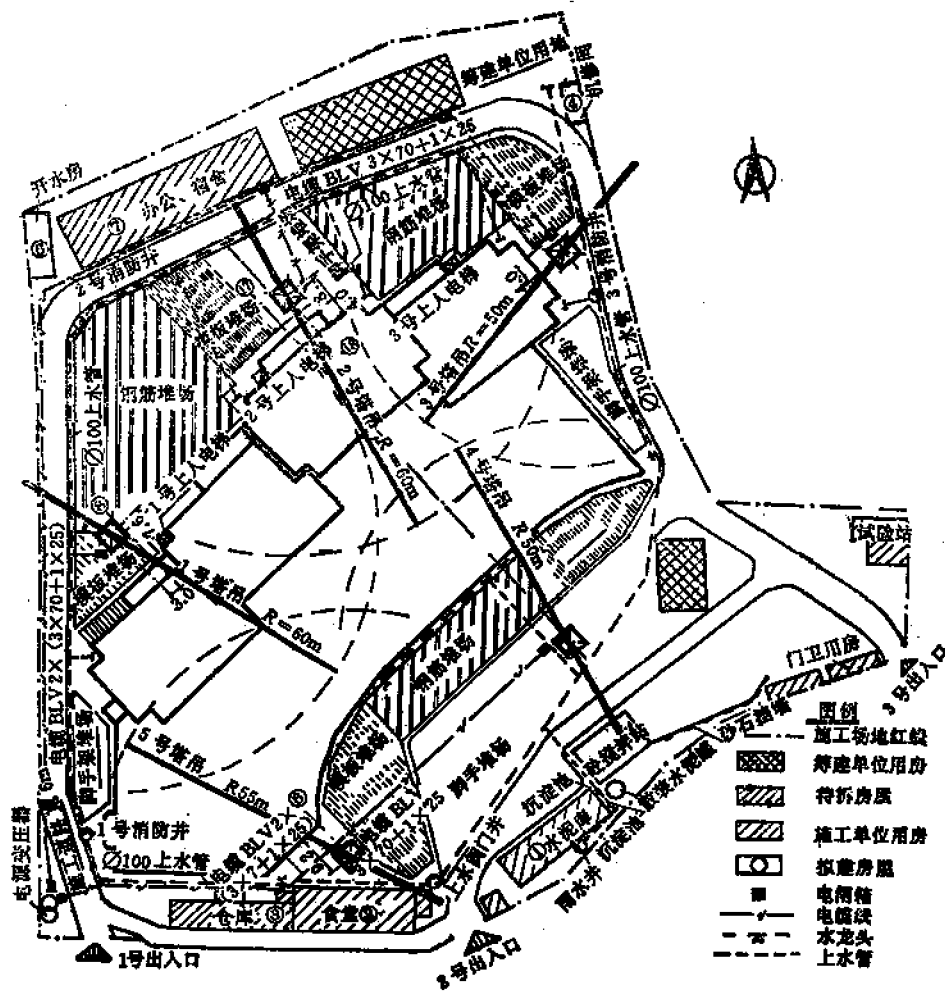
(7) 北京城乡贸易中心工程地上工程施工平面图
